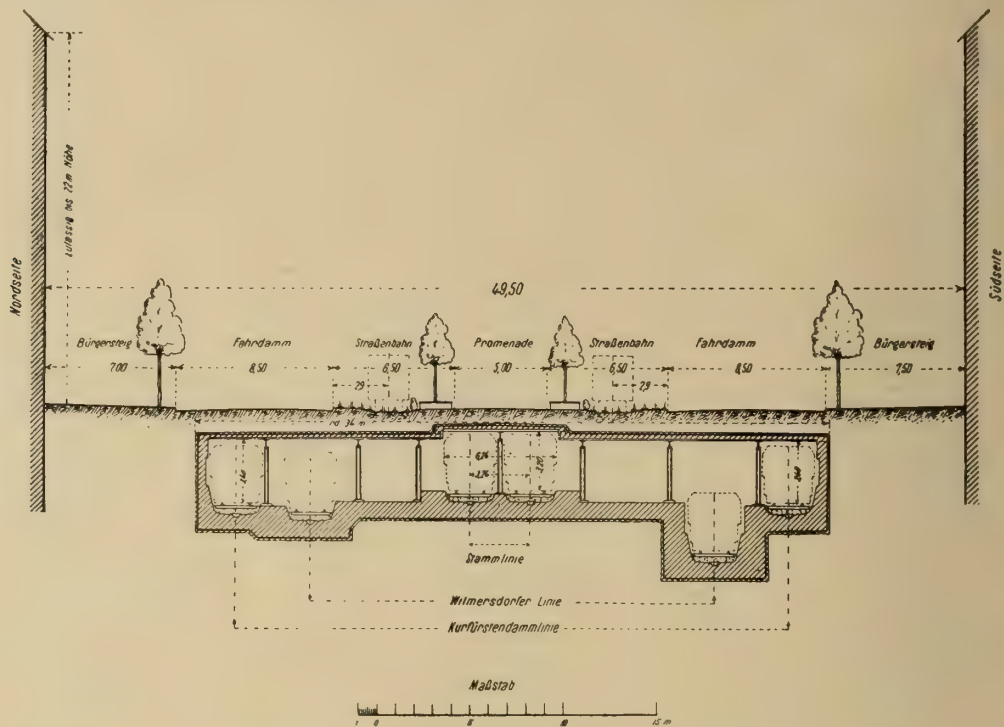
Tauentzienstraße mit Untergrundbahn.
